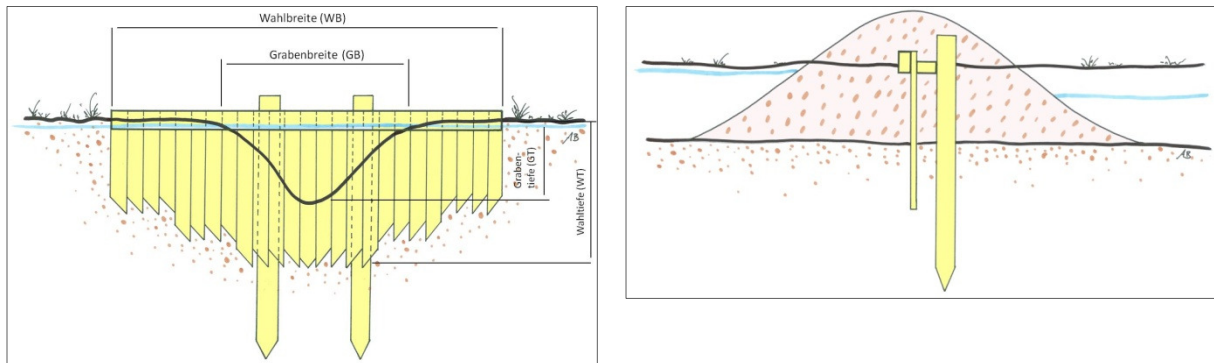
Spundwanddamm (SW), Frontalansicht und Schnitt
